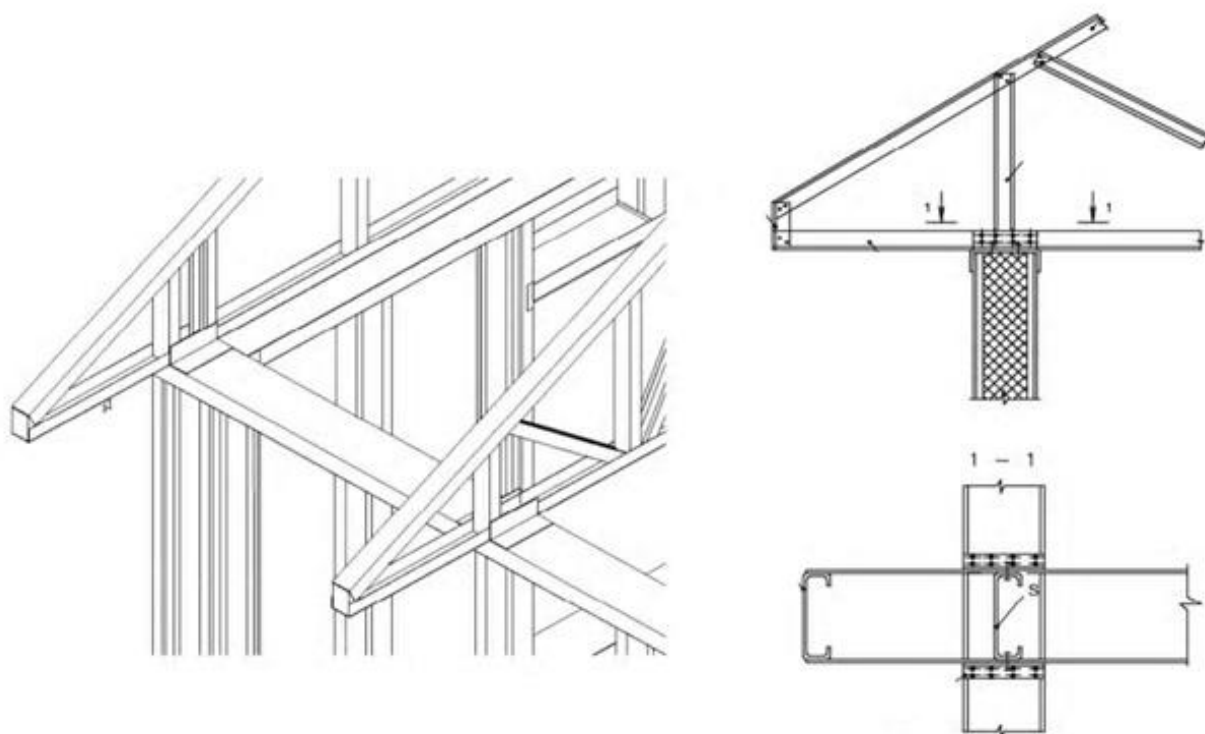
Конструктивное решение опорного узла стропильной фермы
